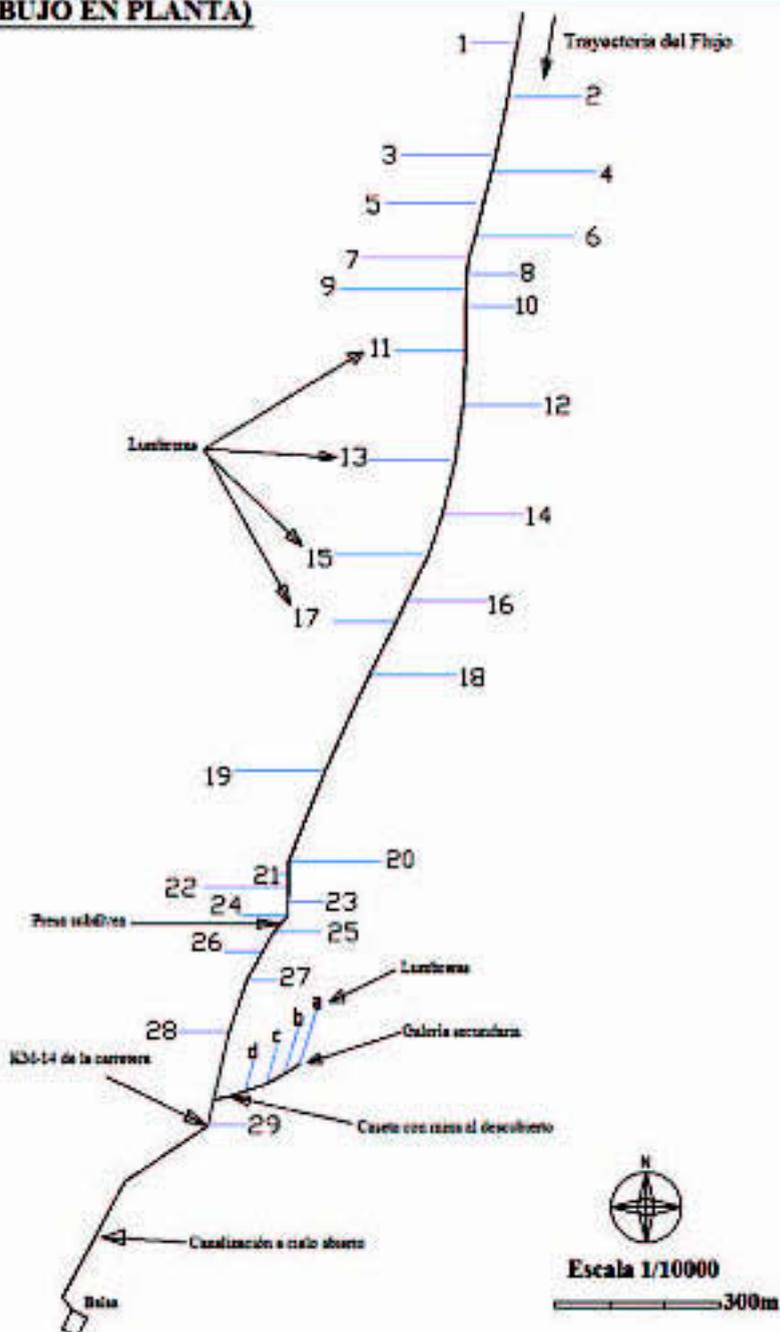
Dibujo en planta del Sistema de galerías con lumbreras encontrado en el paraje de Las Tobarrillas (Yecla).
